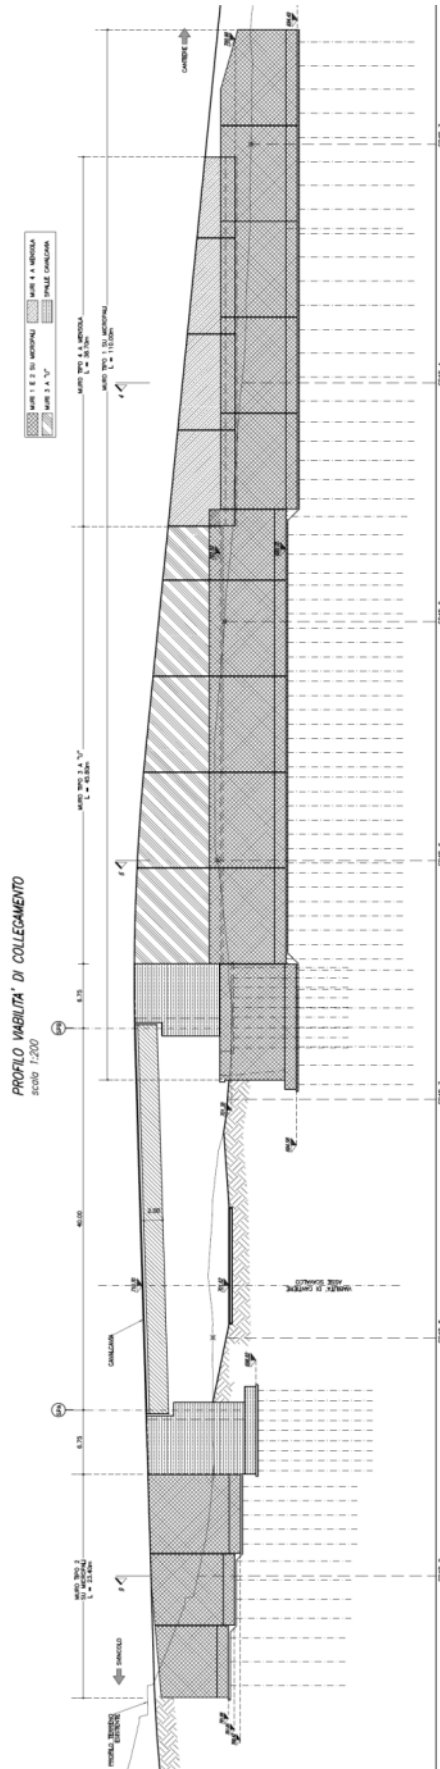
Profilo su Viabilità di Accesso al Cantiere
